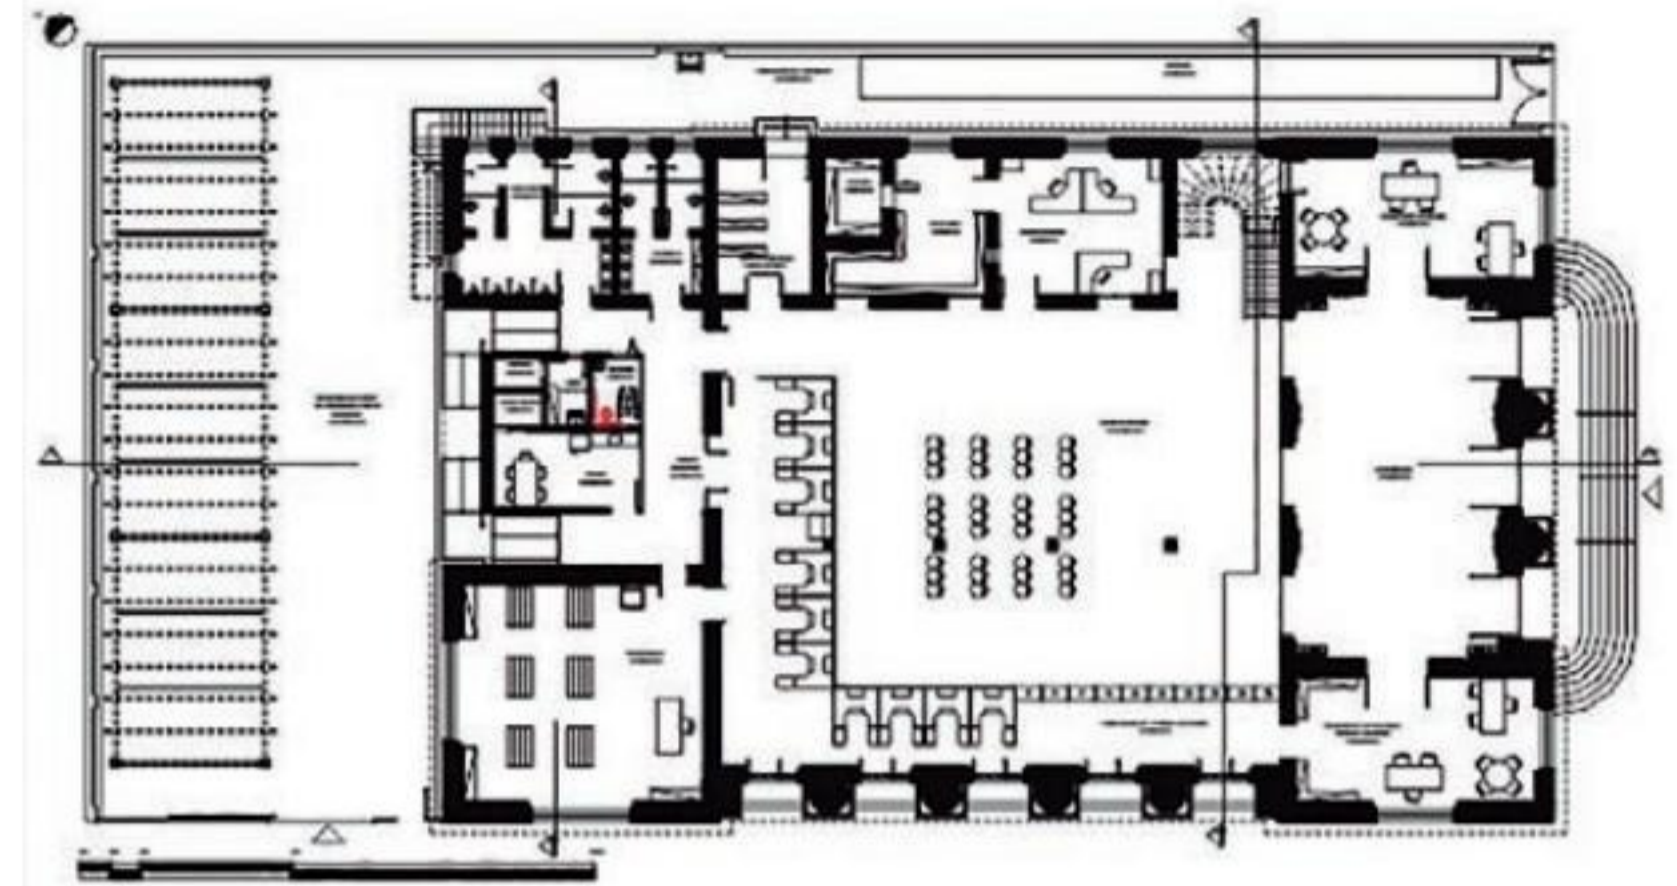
Proposta de intervenção – planta pavimento térreo. Ver MACHADO (2007).
